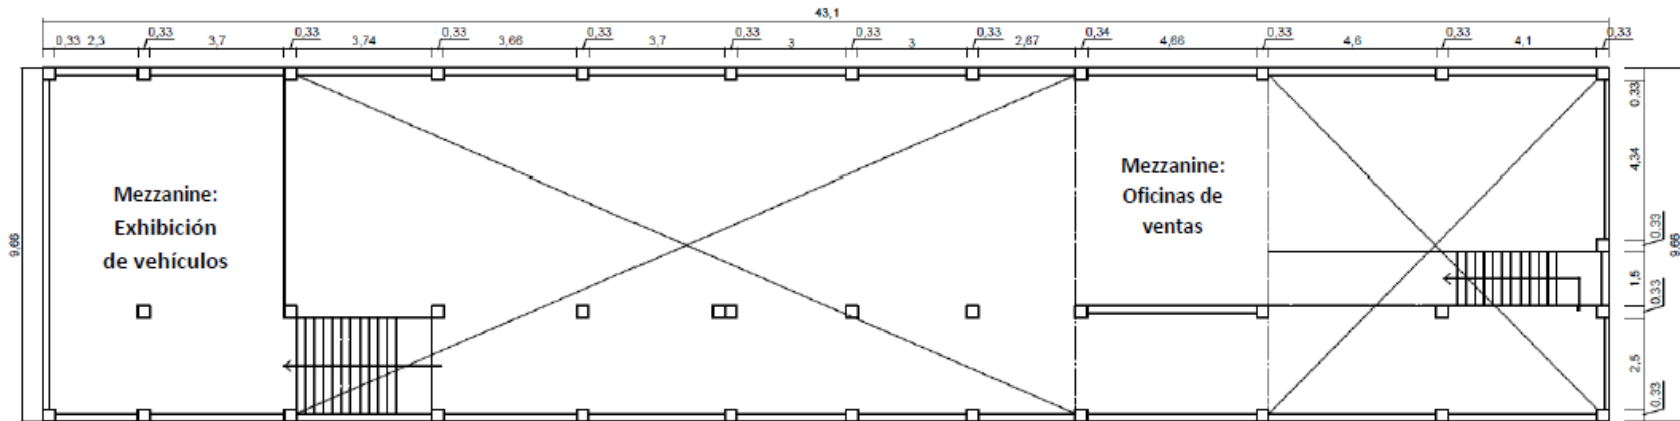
Planos de tienda principal – Mezzanine – 1 piso
